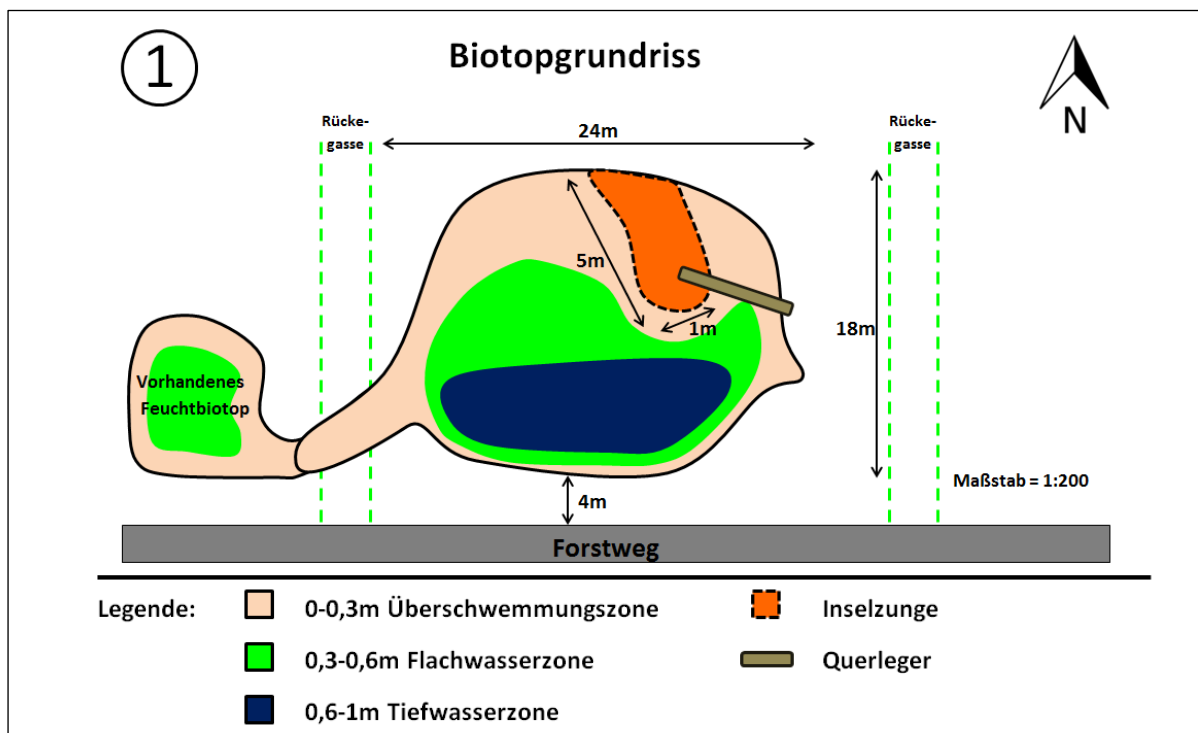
Grundriss von Biotop Nr. 1
